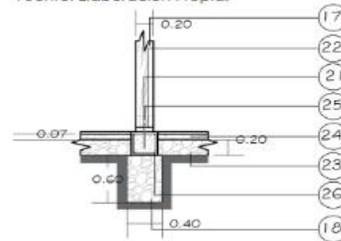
Detalle 3(Contrapiso)-Esc:1/50
